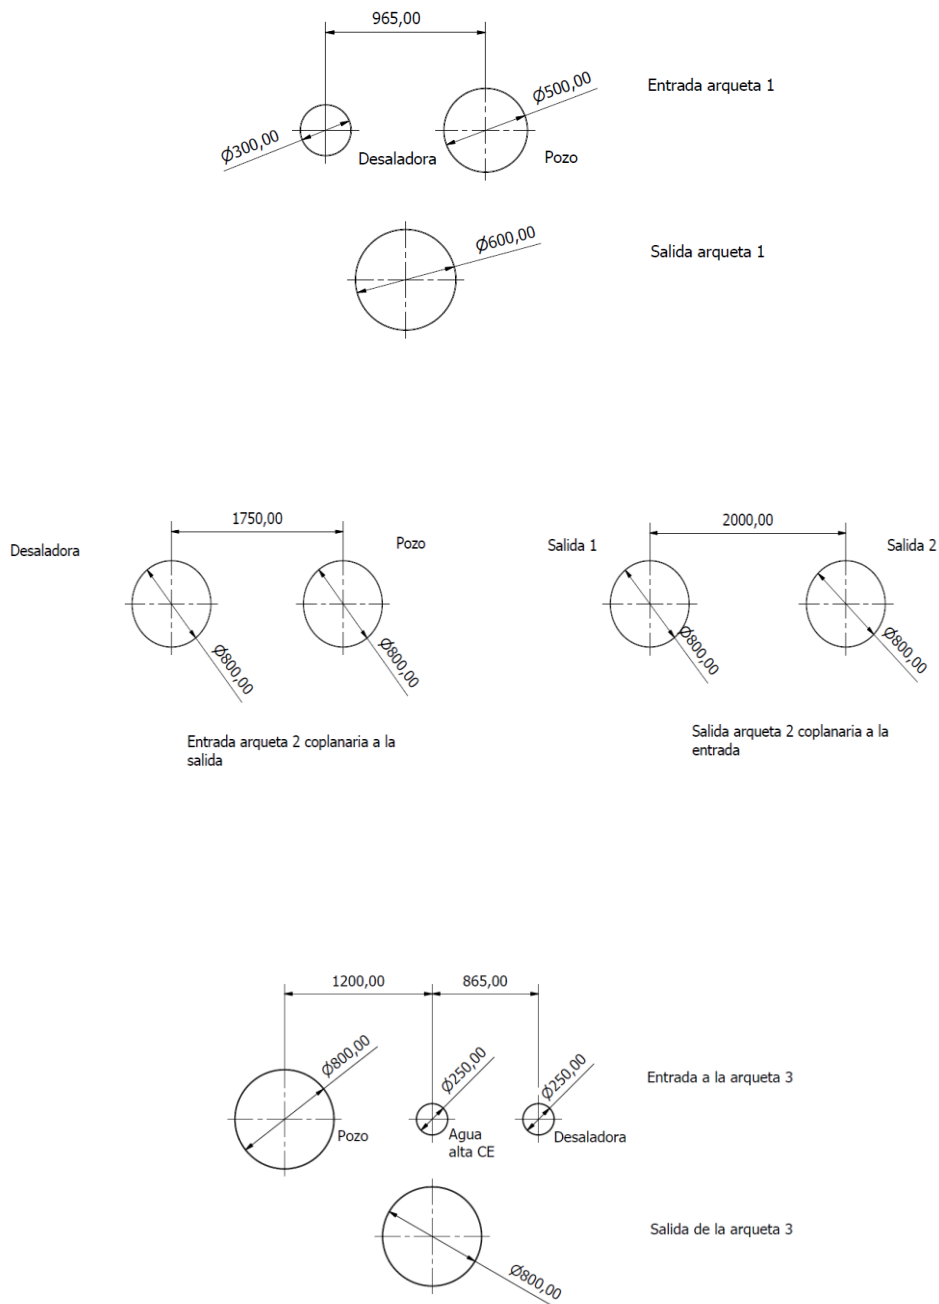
Superior: Arqueta constructiva 1. Medio: Arqueta constructiva 2 .Inferior: Arqueta constructiva 3.
